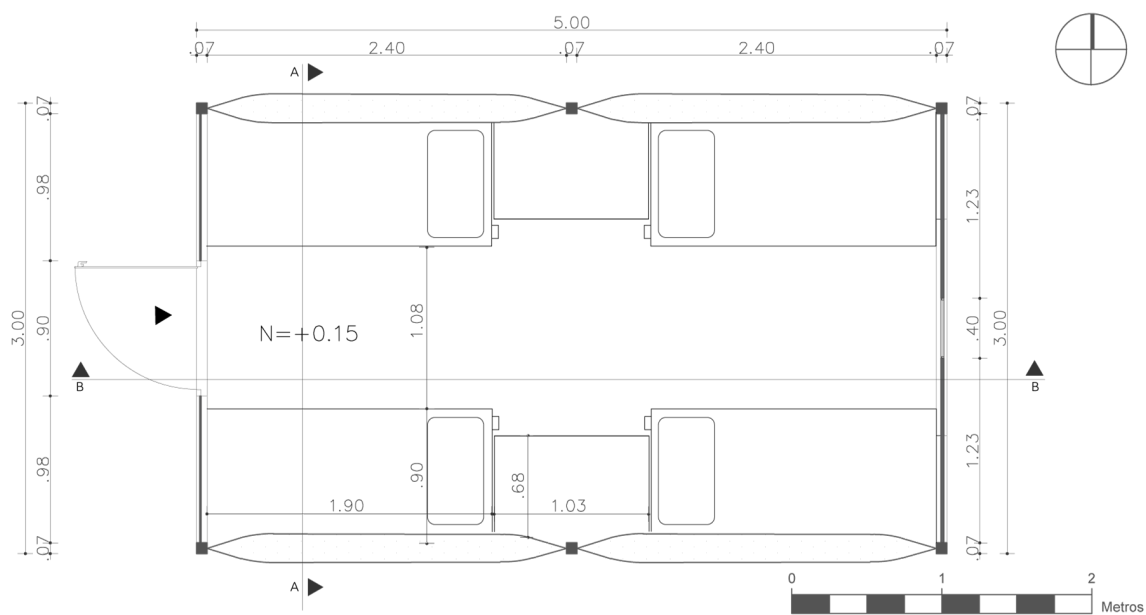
Habitáculo Burbuja Zona de descanso. Elaboración: Autores
